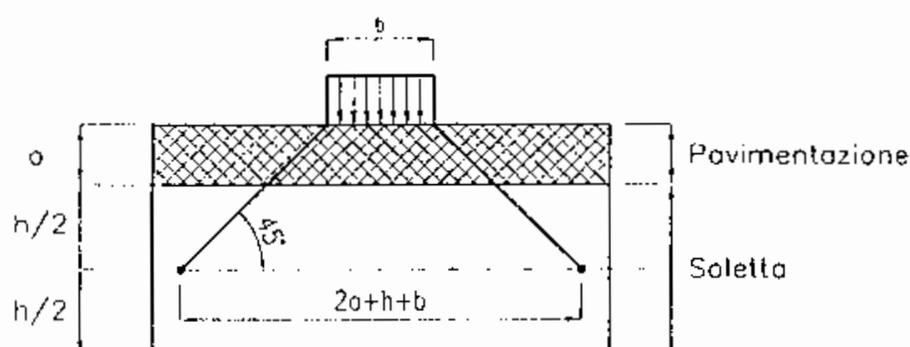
Diffusione dei carichi concentrati attraverso la pavimentazione e le solette
